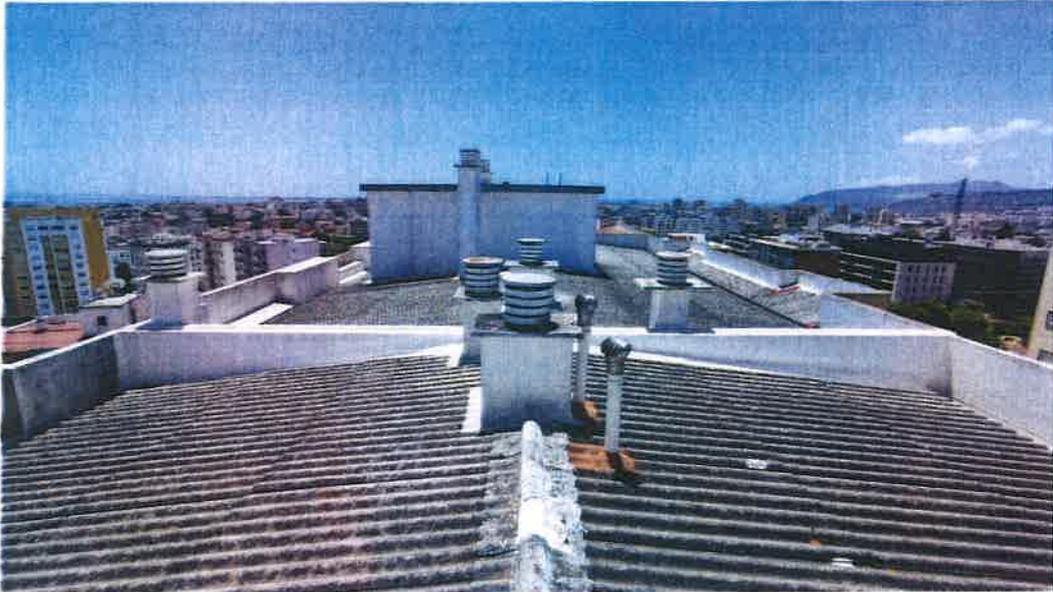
e 12 – Cobertura – Junta dilatação horizontal e vertical - fissuras
